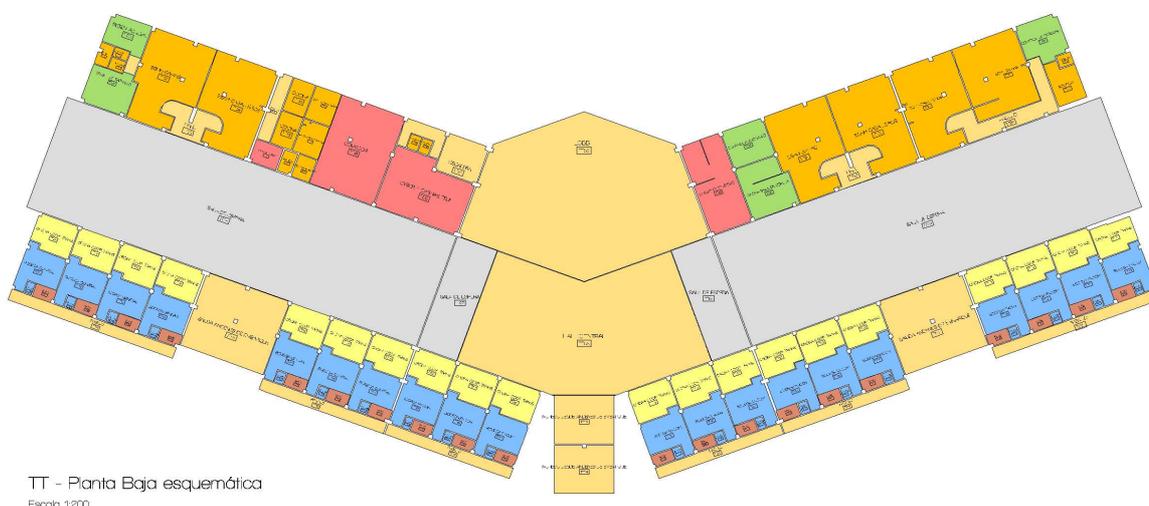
Planta esquemática de la Terminal de Pasajeros
